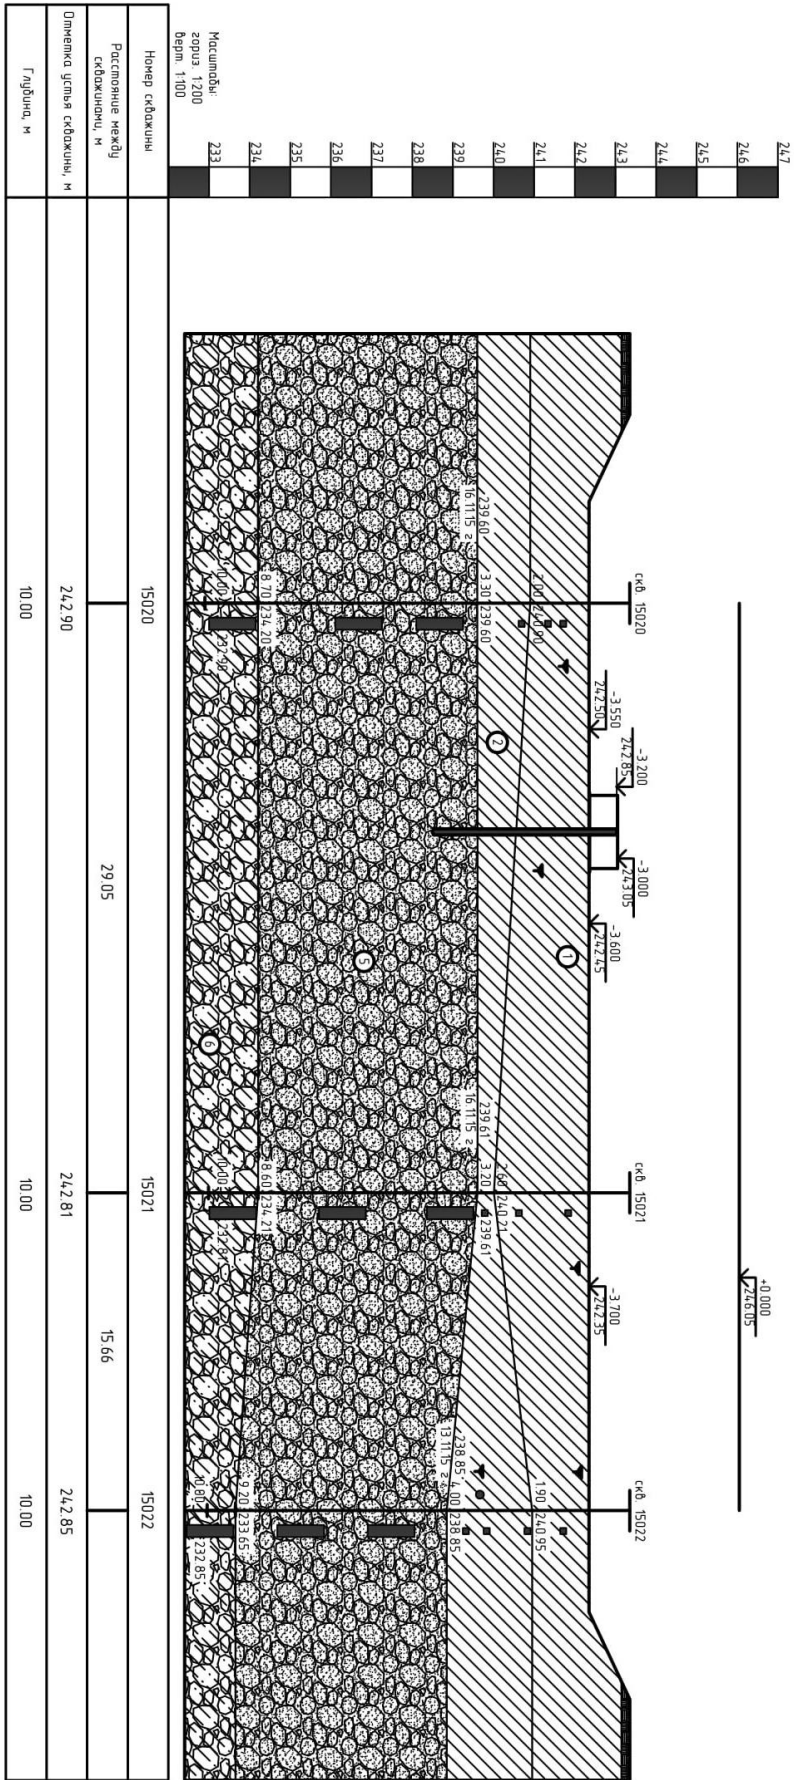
Геологический разрез со строительной площадки II–II
